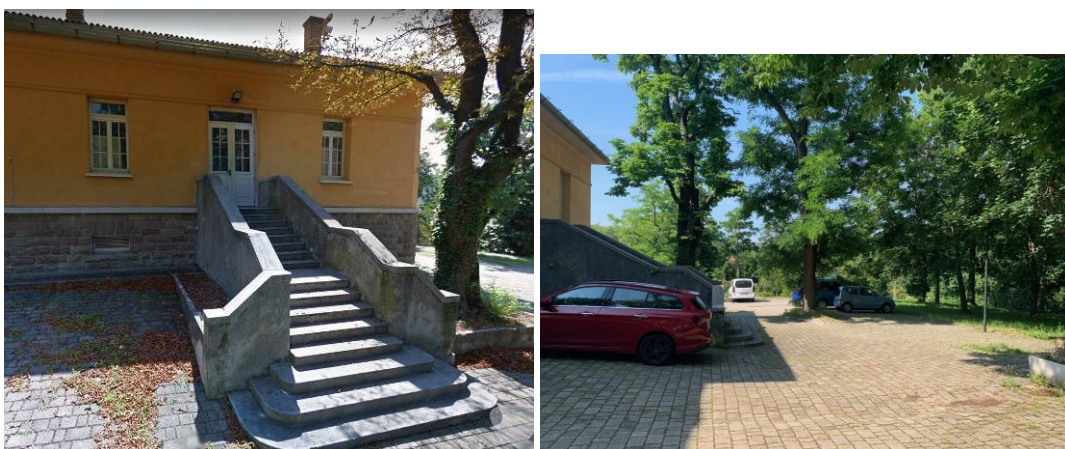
Vista dell'edificio dall'ingresso principale (lato via P. De Ralli)
